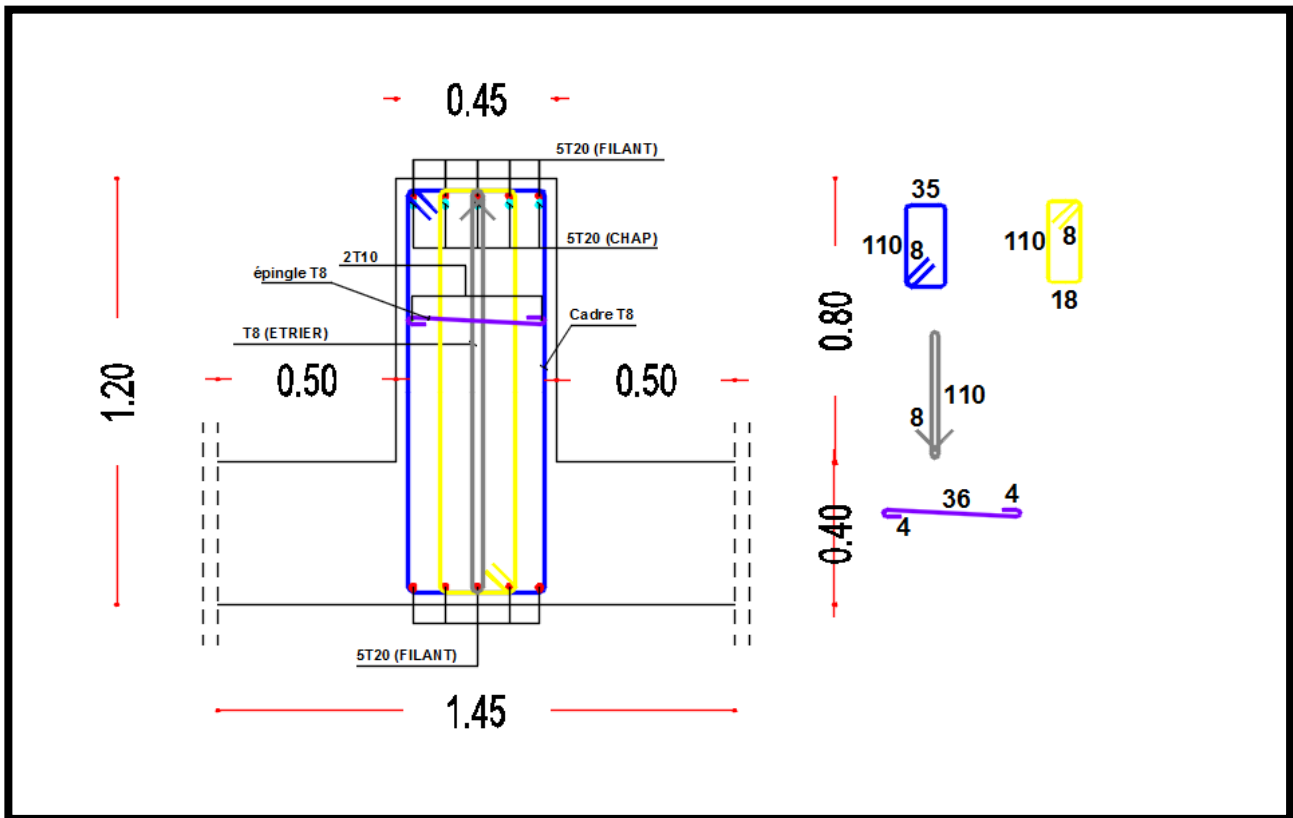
schéma de ferrailage de la poutre secondaire en travée
